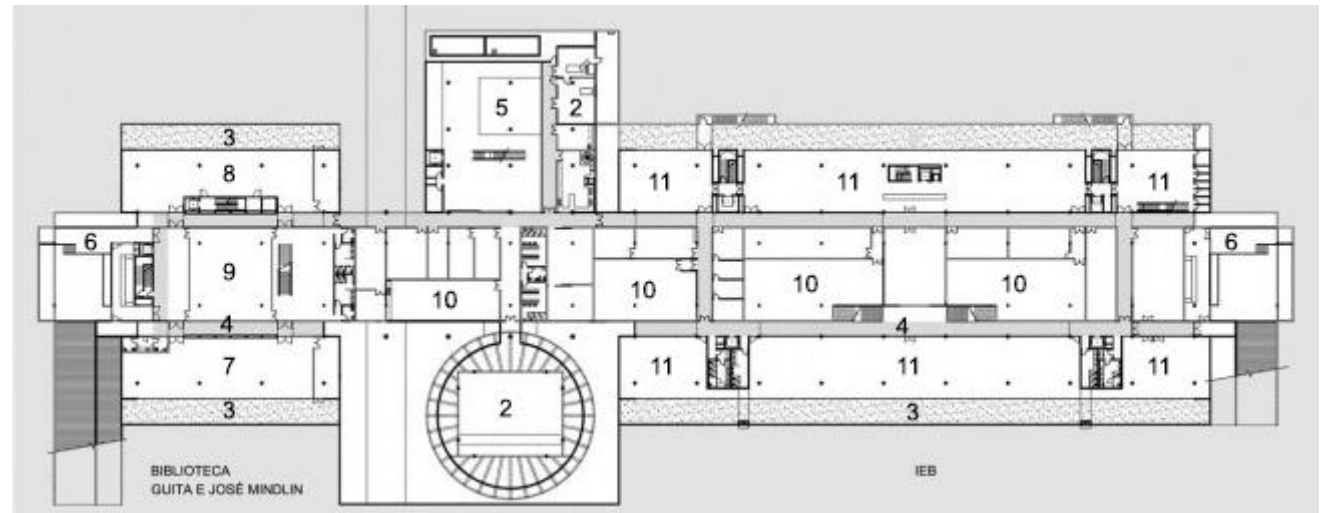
Planta baixa pav. inferior. Fonte: Archdaily (2019c).
